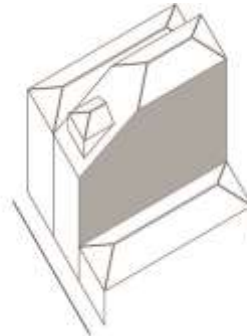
| Empena lateral com recorte comum e coroamento misto de água-mestra e tacaniça simples. Pode observar-se a tacaniça quer na fachada principal, quer na fachada posterior. (desenho do autor)
